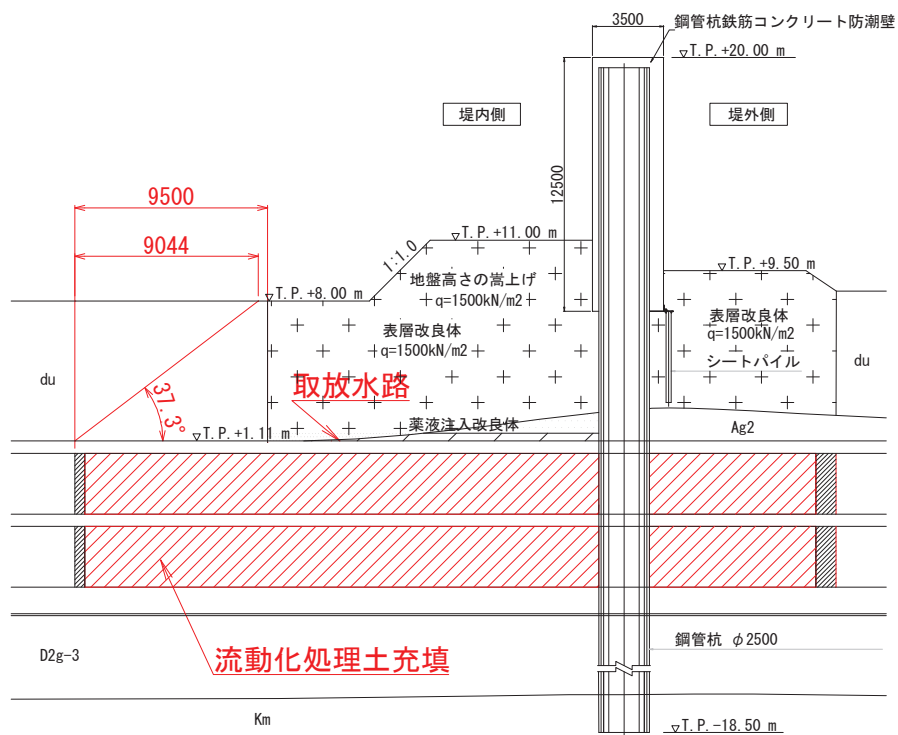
取放水路埋戻し位置断面図（B-B断面）
